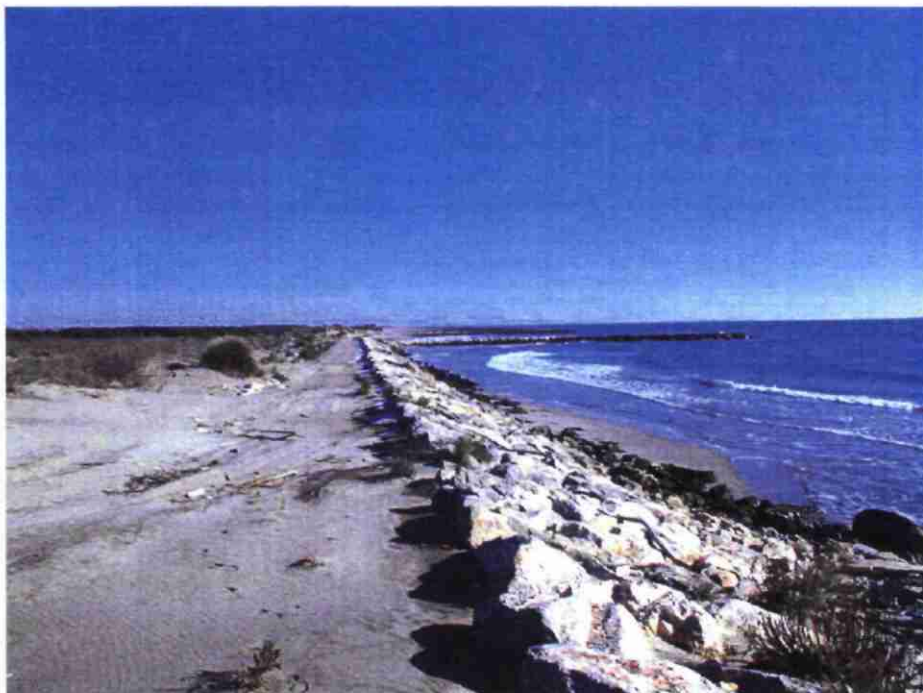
ouvrage type "digue frontale" ; au fond épis n°28 et 29 raccordés à la digue
